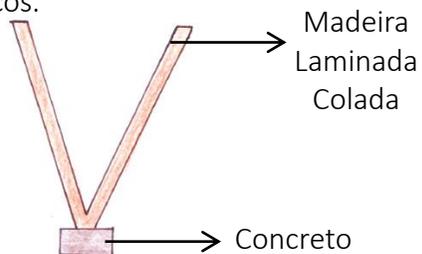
Croqui do pilar estrutural do Centro de Convivência
